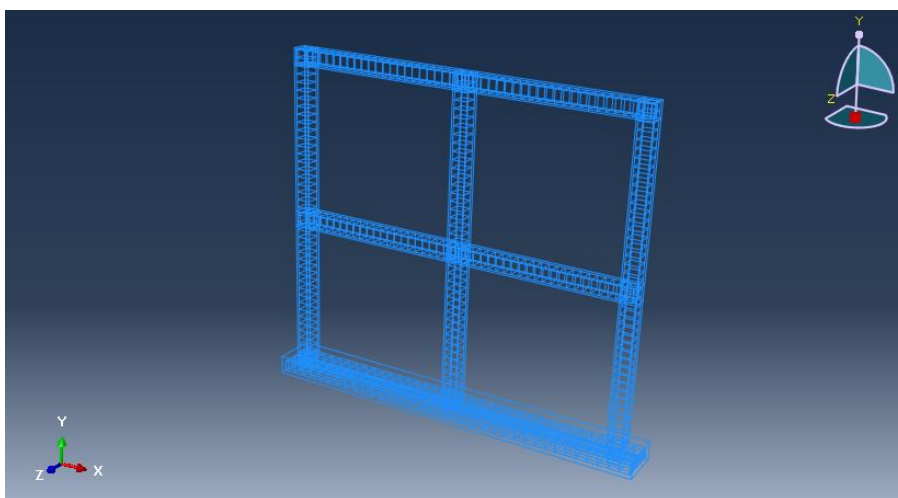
Ferrailage des poteaux, poutres et semelle du portique à 2 travées 2 étages
